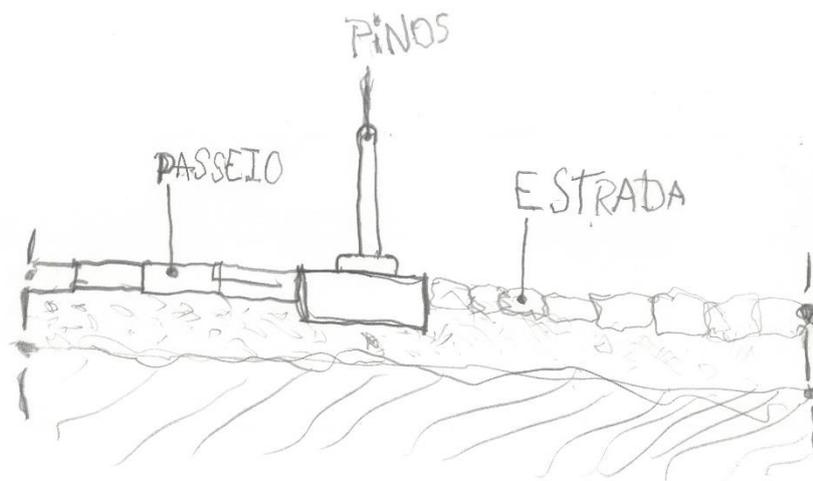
Esquízo de pormenor 2 do pavimento do espaço público do bairro da Parcela 6, em corte
